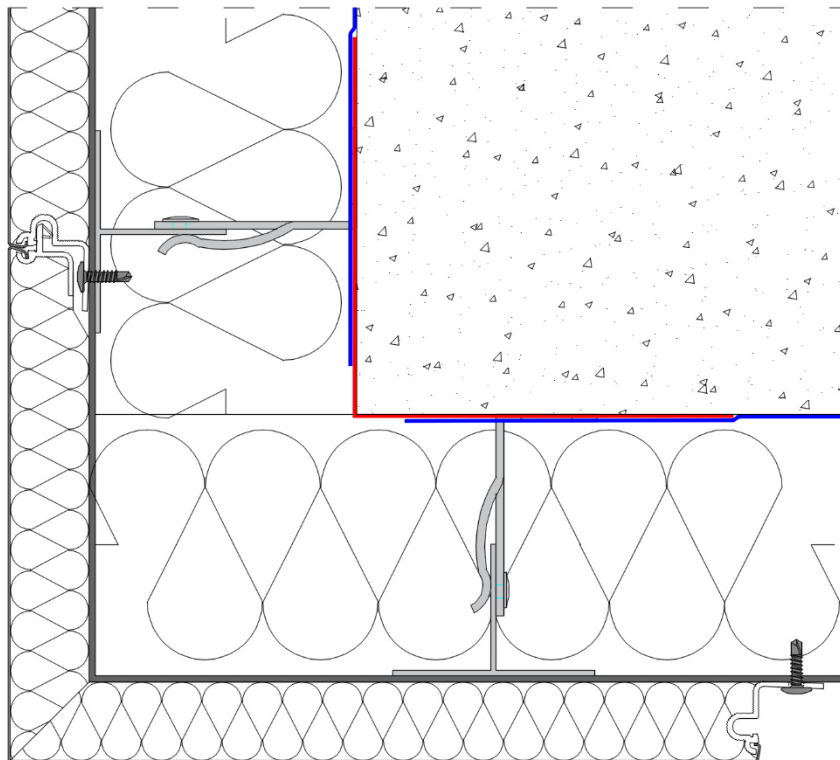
Angle sortant – Principe de façonnage des panneaux MYRAL - Lame verticale (coupe horizontale)
